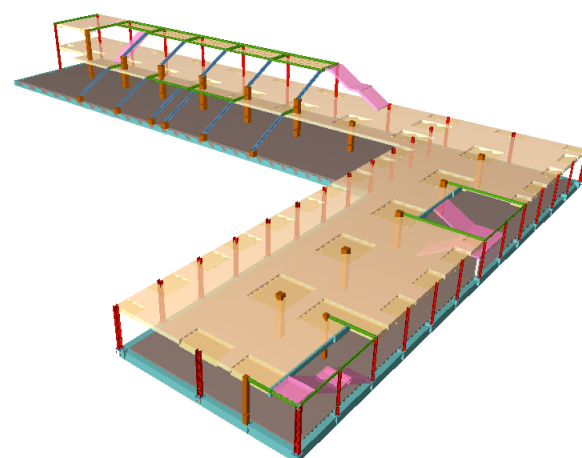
Fase 4 – Ejecución de forjados de la segunda planta y escaleras de acceso a gradas. Fuente: Propia.
